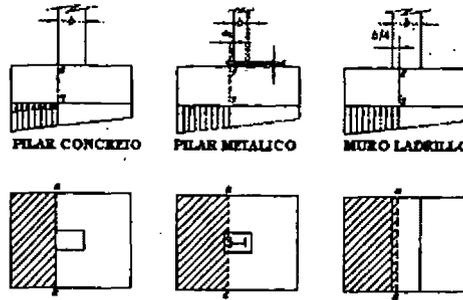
Secciones y áreas de cálculo de la flexión.
